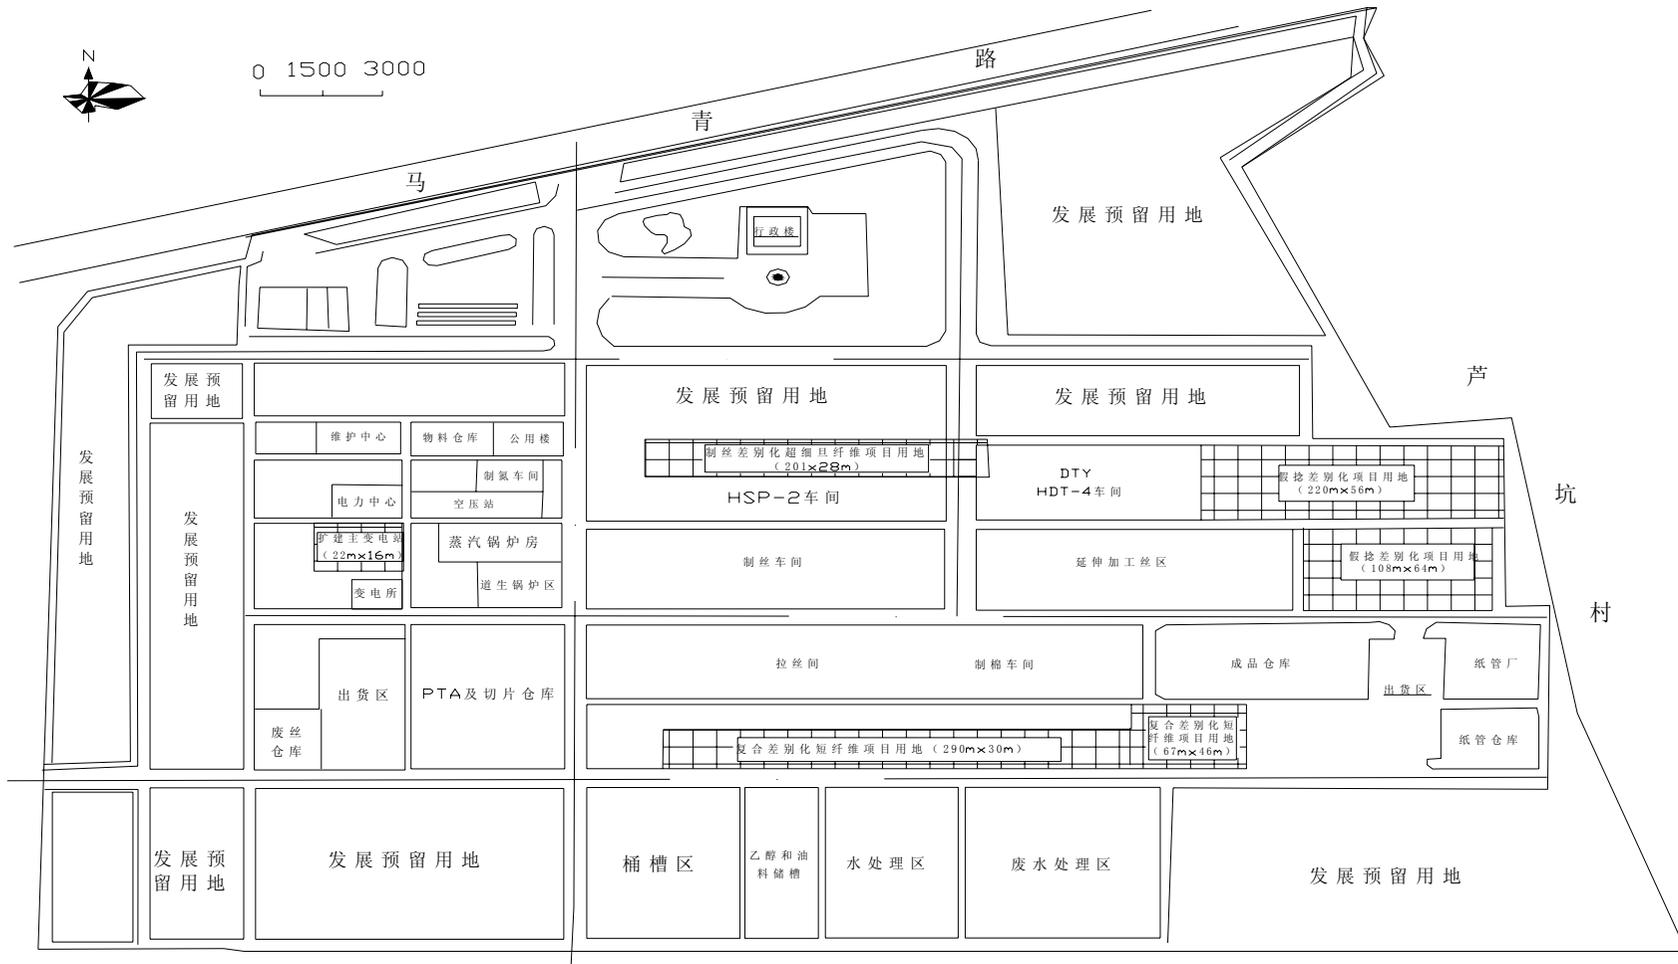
翔鹭涤纶纺纤（厦门）有限公司总平面布置图
